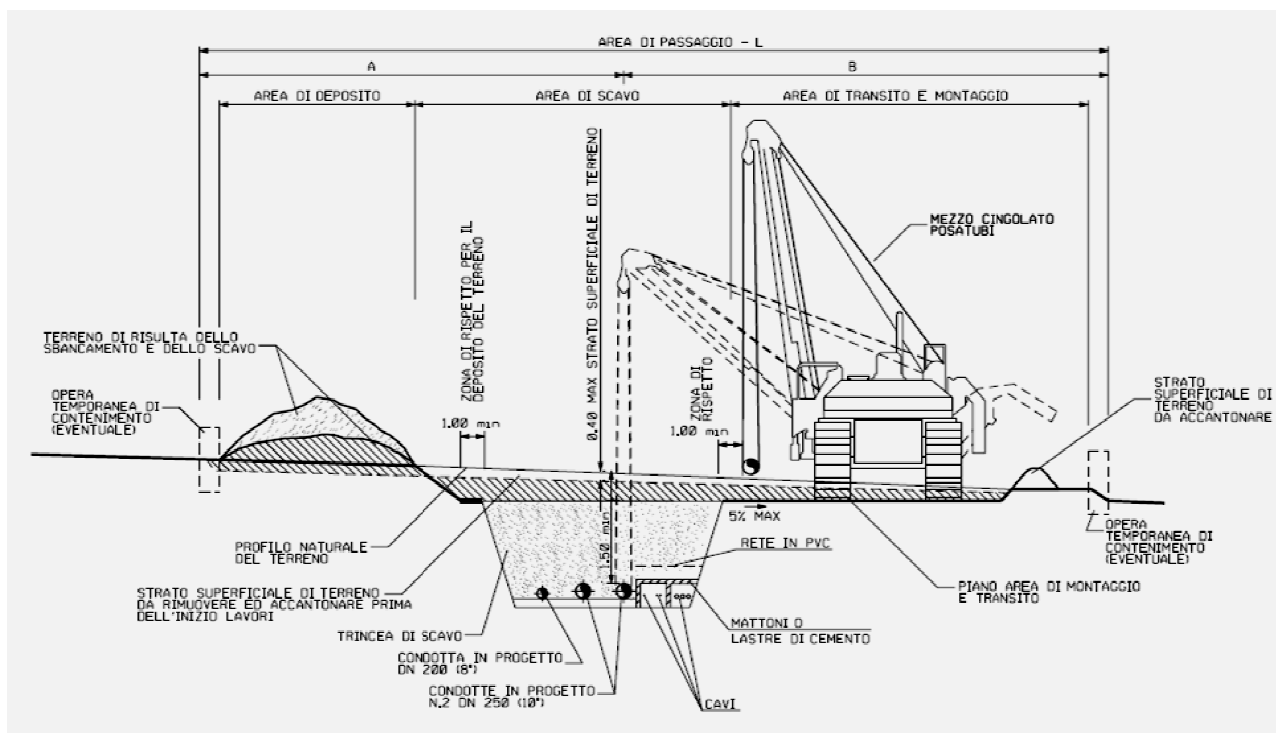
tipico pista di lavoro (Fonte: Standard di progetto – Progetto Pergola 1, eni – 27 Giugno 2013)
